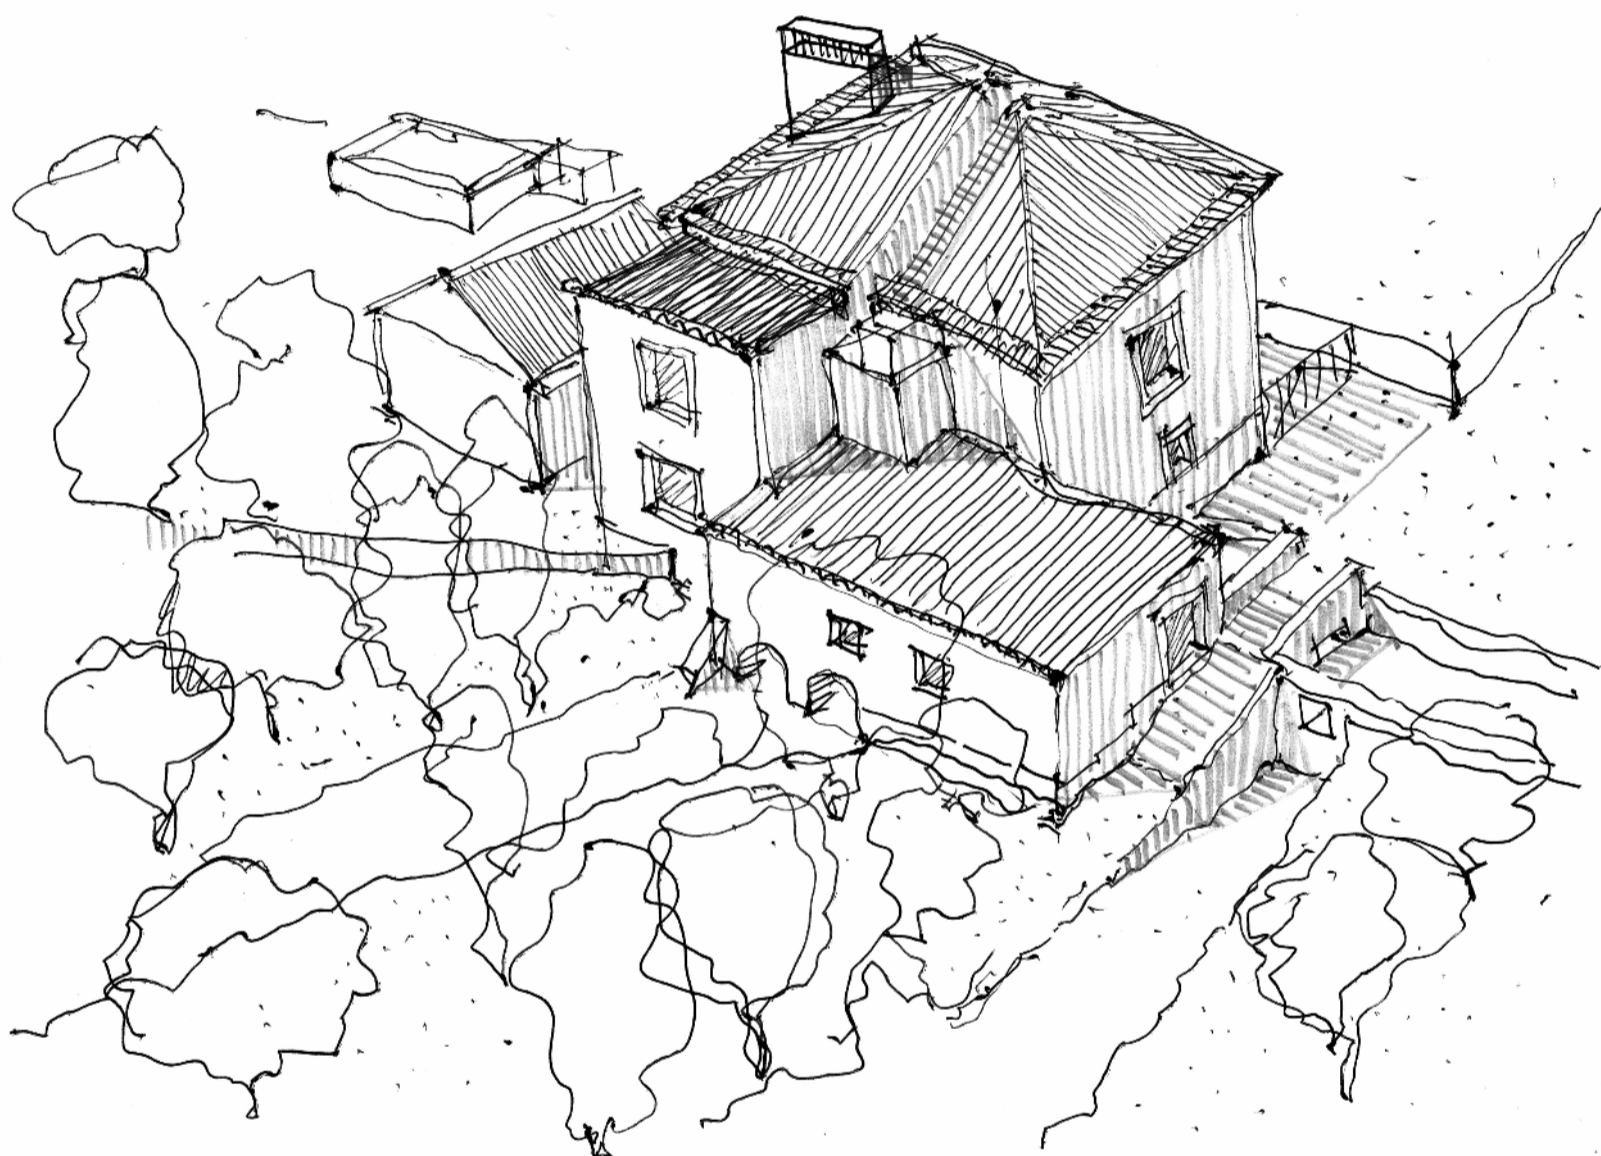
| Moinho da Ponte de Évora, vista norte e nascente a partir da leitura do edificado actual.
